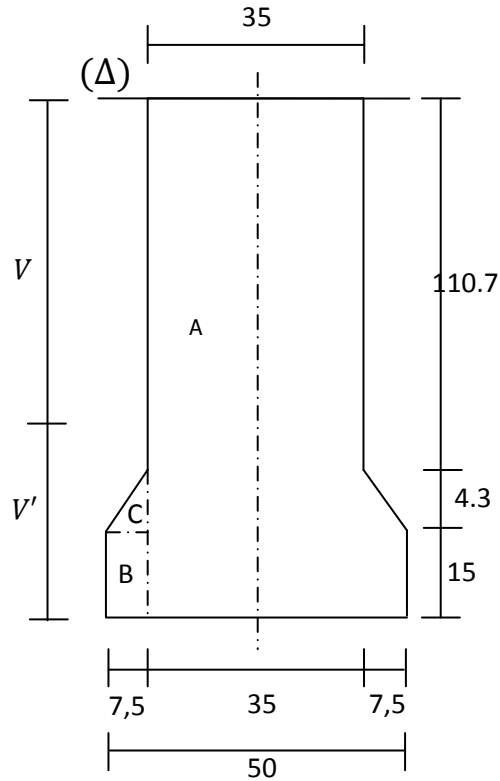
Poutre seule section d'about (intermédiaire et rive).
